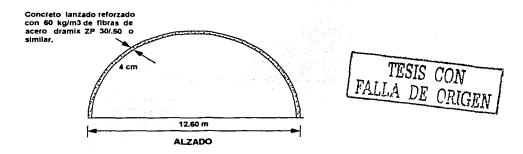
Colocación de una capa primaria de concreto lanzado reforzado con fibras de acero, hasta alcanzar un espesor de 4 cm.
